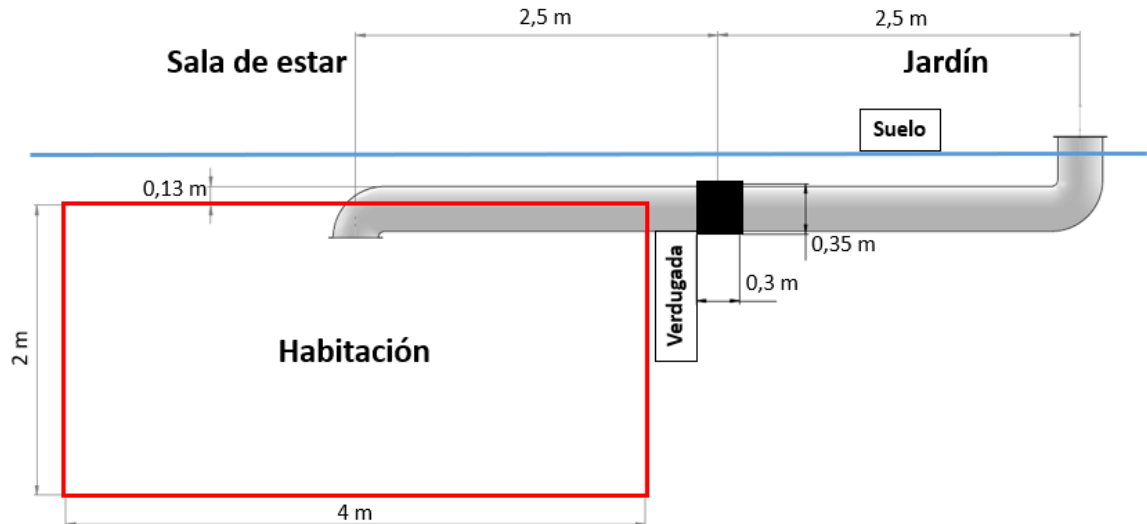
Vista de perfil de la tubería y la habitación<sup>43</sup>.
